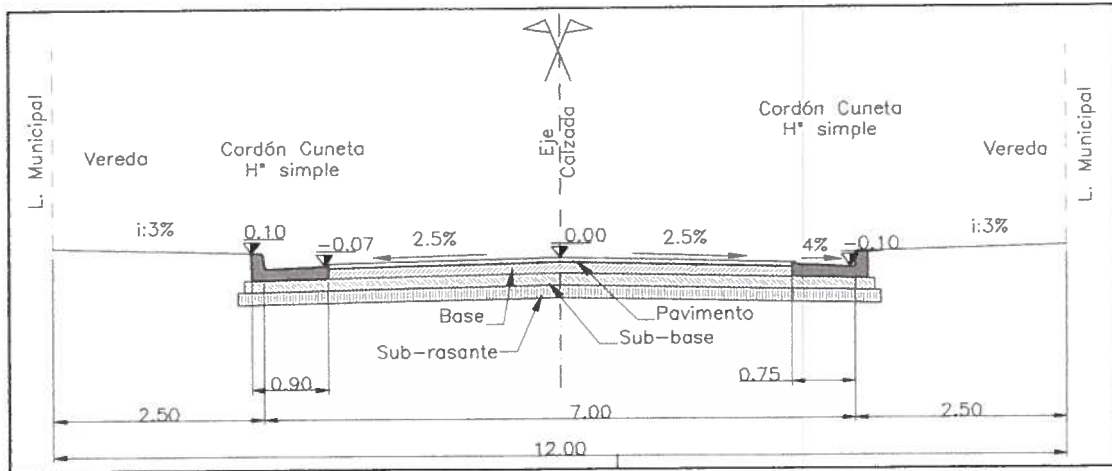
Perfil transversal tipo 1. Calzada Pavimento
